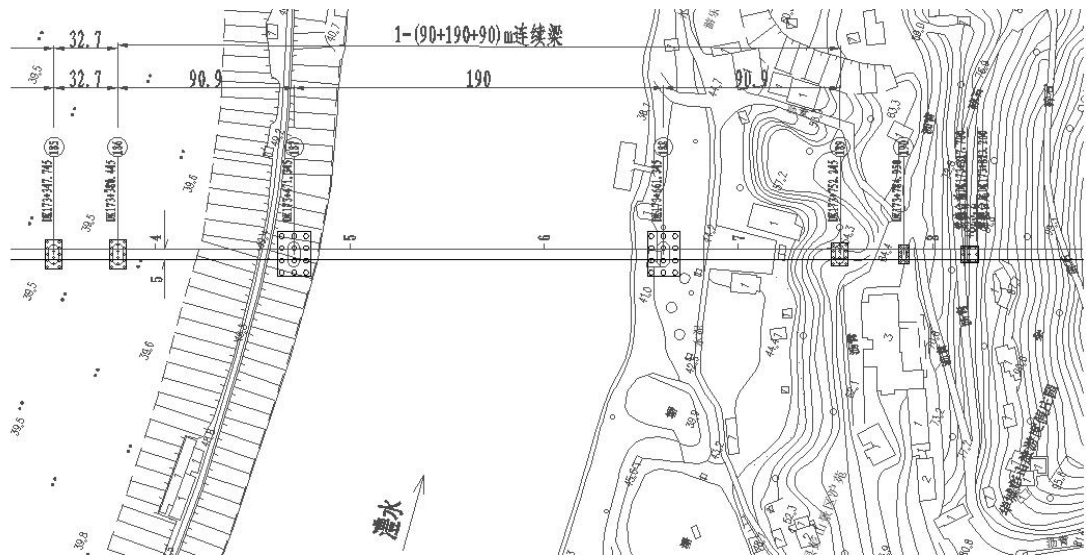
澧县澧水特大桥跨越澧水航道桥址平面图
